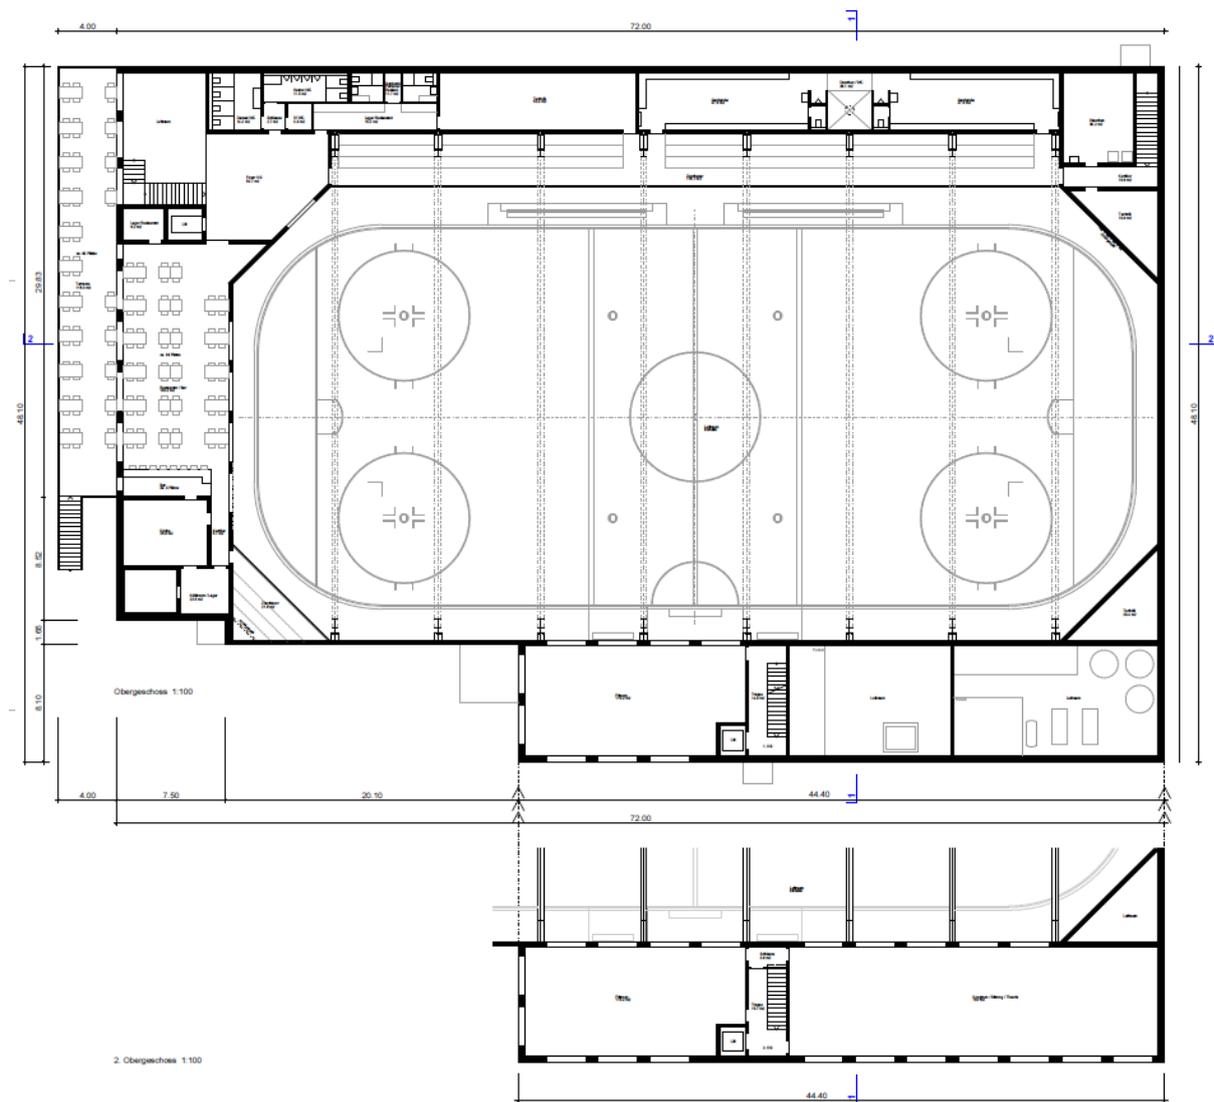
Grundriss 1. und 2. Obergeschoss (Quelle: Ricci Architekten, Brig).
